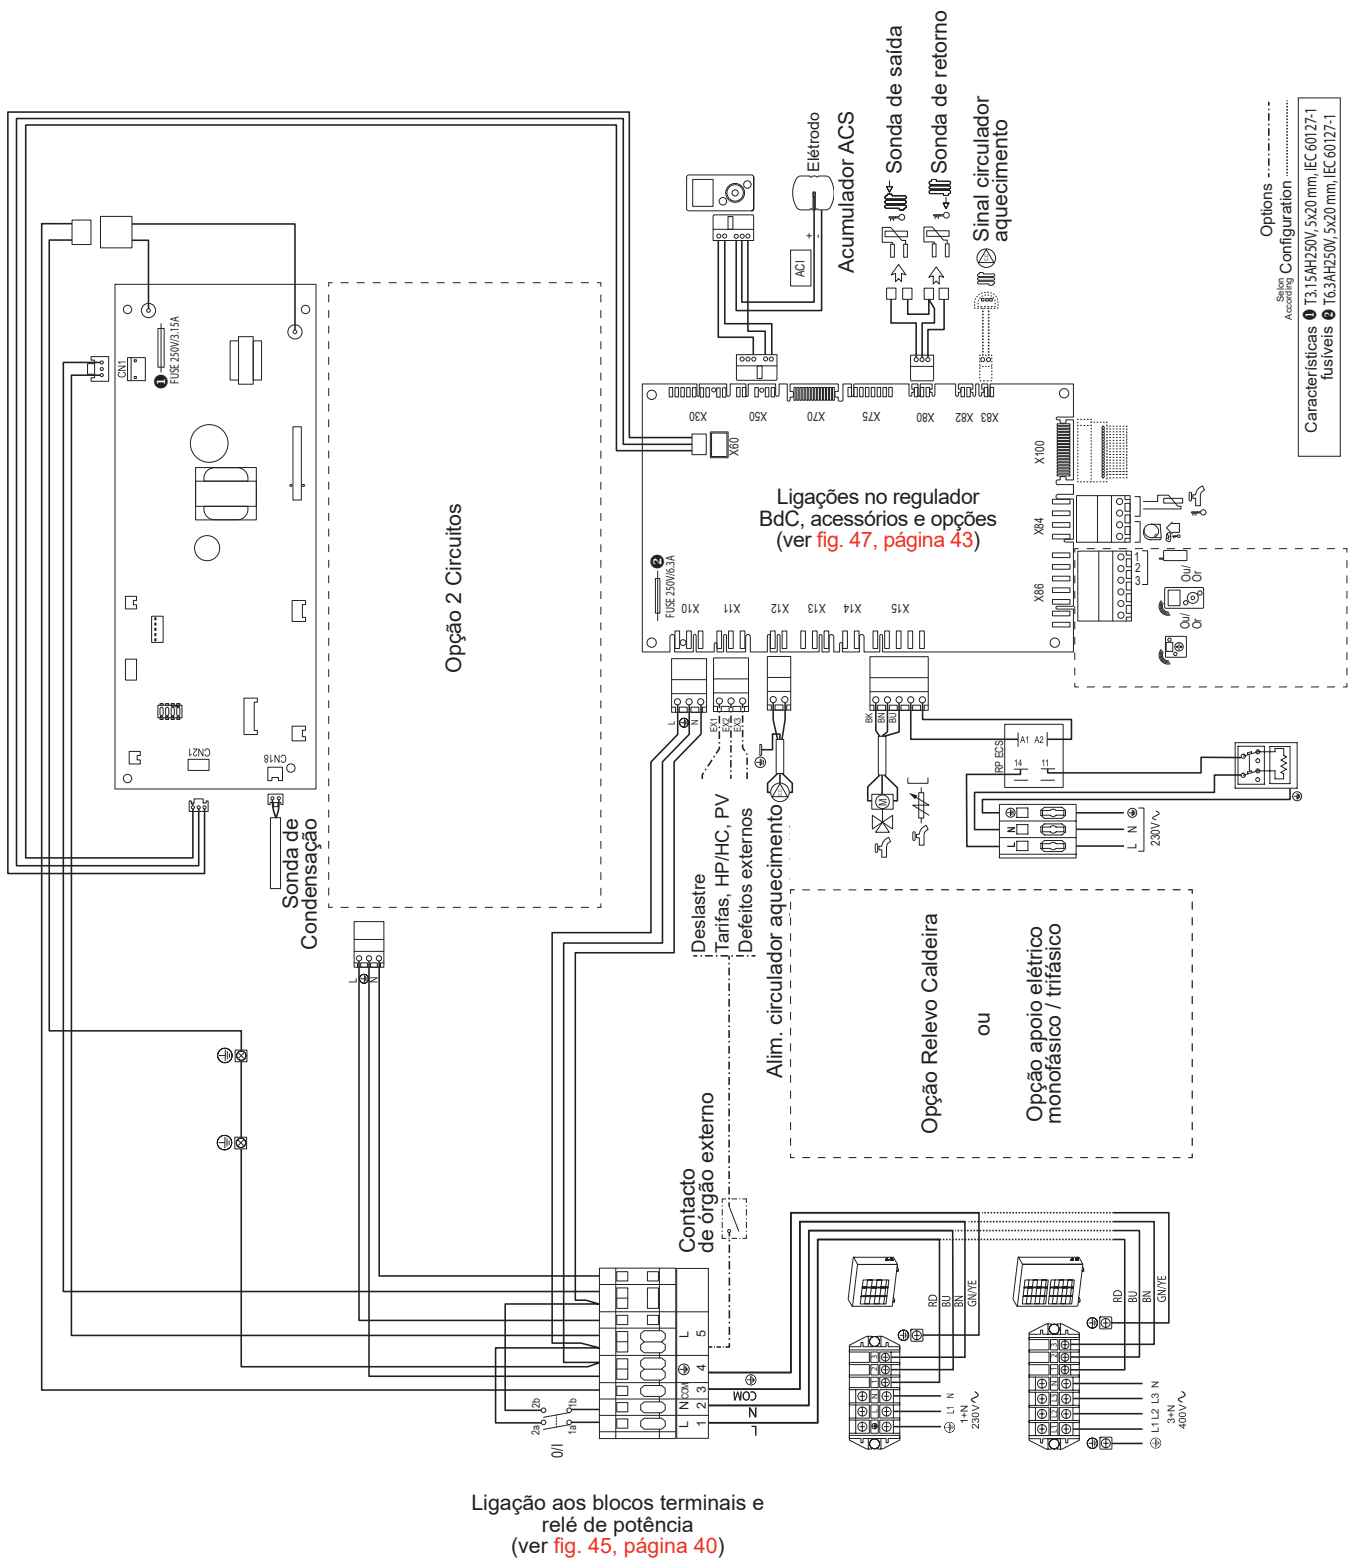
Cablagem elétrica módulo hidráulico (salvo ligações do instalador)
